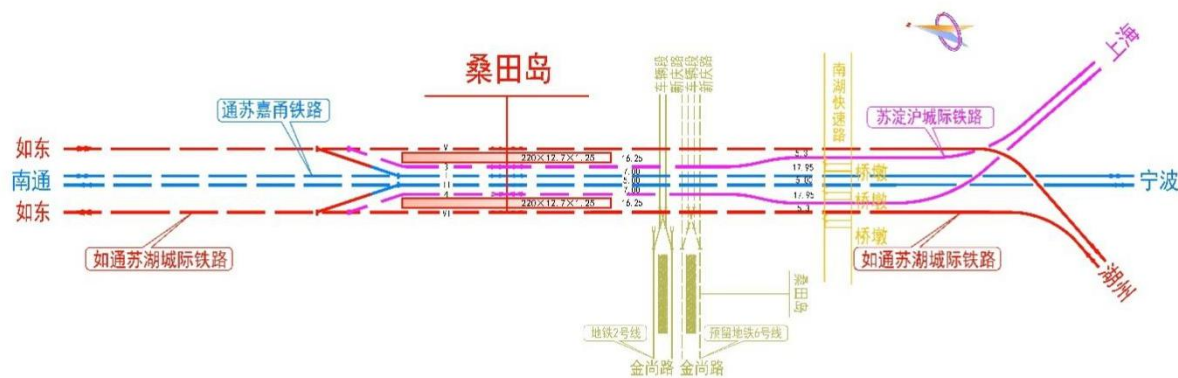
优化后桑田岛站 2 岛 6 线方案平面布置示意图
